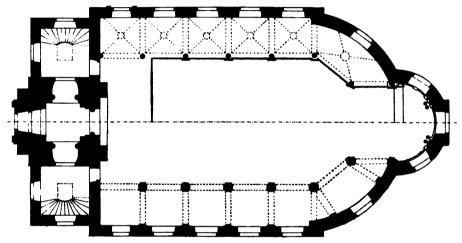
, St. Clement Danes church, Strand, zu London. Grundriss.
